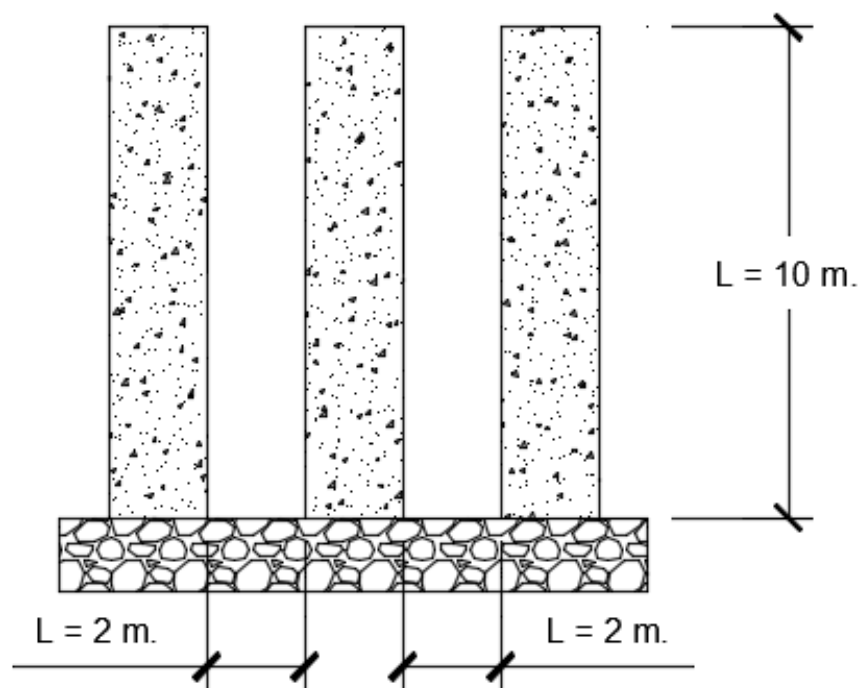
Vista en corte del pilar central (Pilar 2) (Fuente: elaboración propia)
